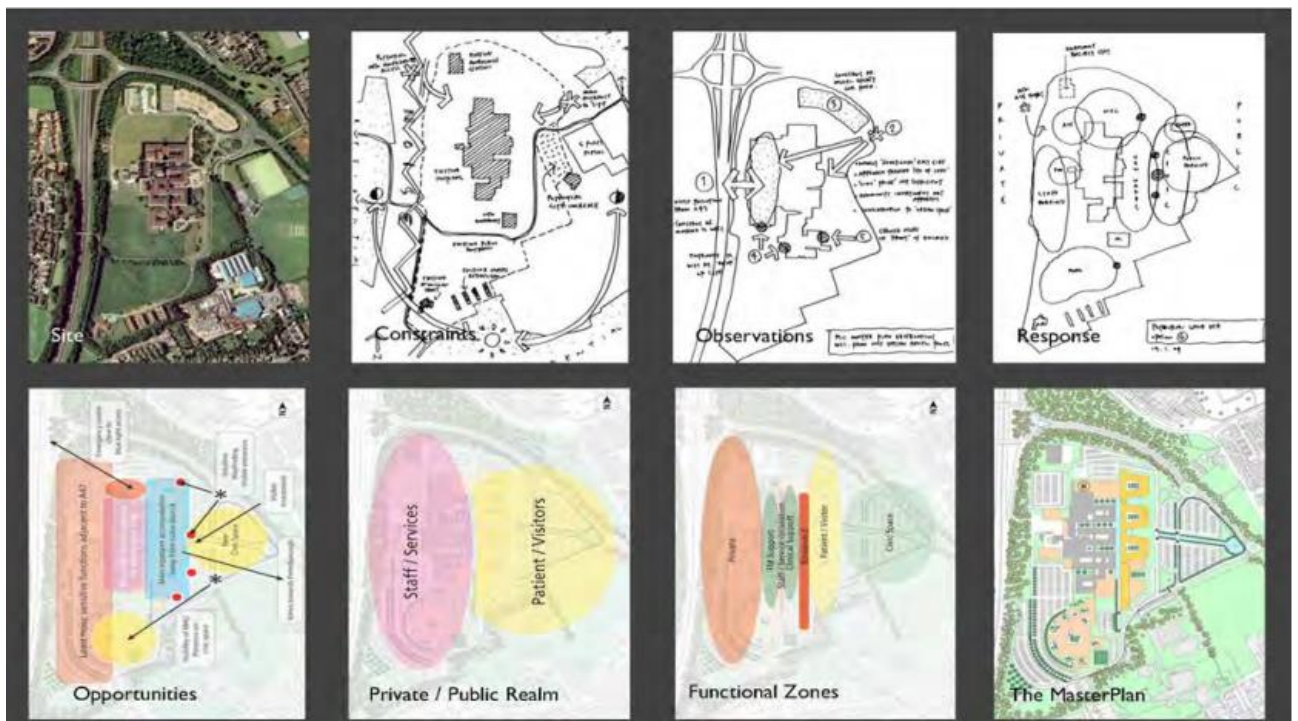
Розробка генерального плану – планування (Лікарня Енніскілін, люб'язно надано Океттом Суонке) [6]
